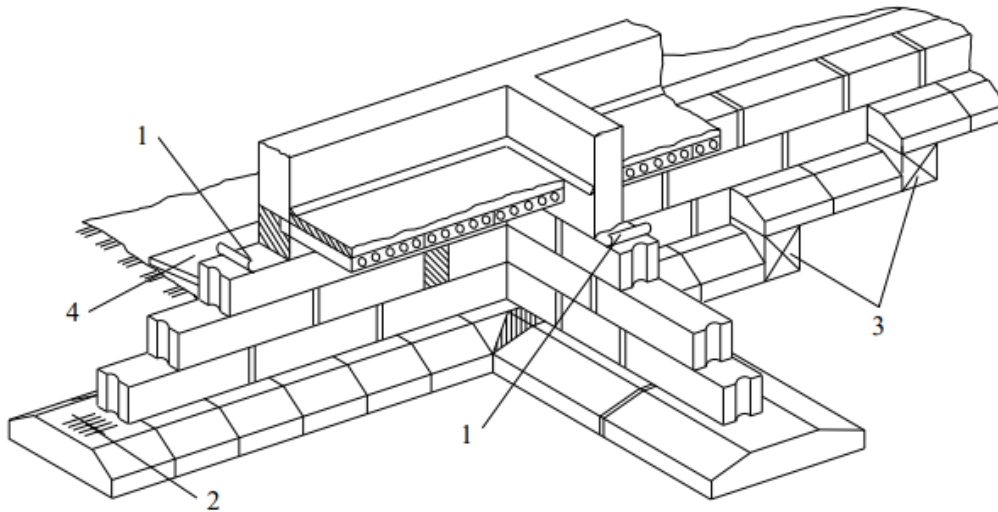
Конструкція збірного стрічкового фундаменту: 1 – протикапілярна гідроізоляція; 2 – армований шов; 3 – перехід від однієї глибини до іншої.
